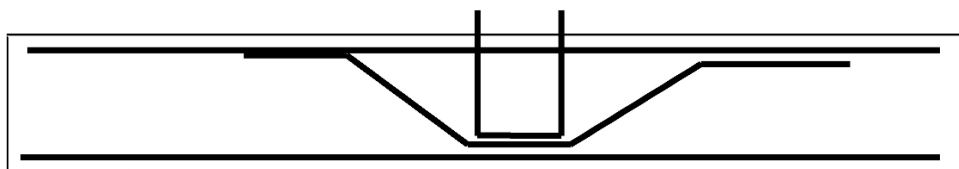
Schubbiegeform, die sich analog mit großen Stabdurchmessern nur ungenau in die obere Lage einbindet
